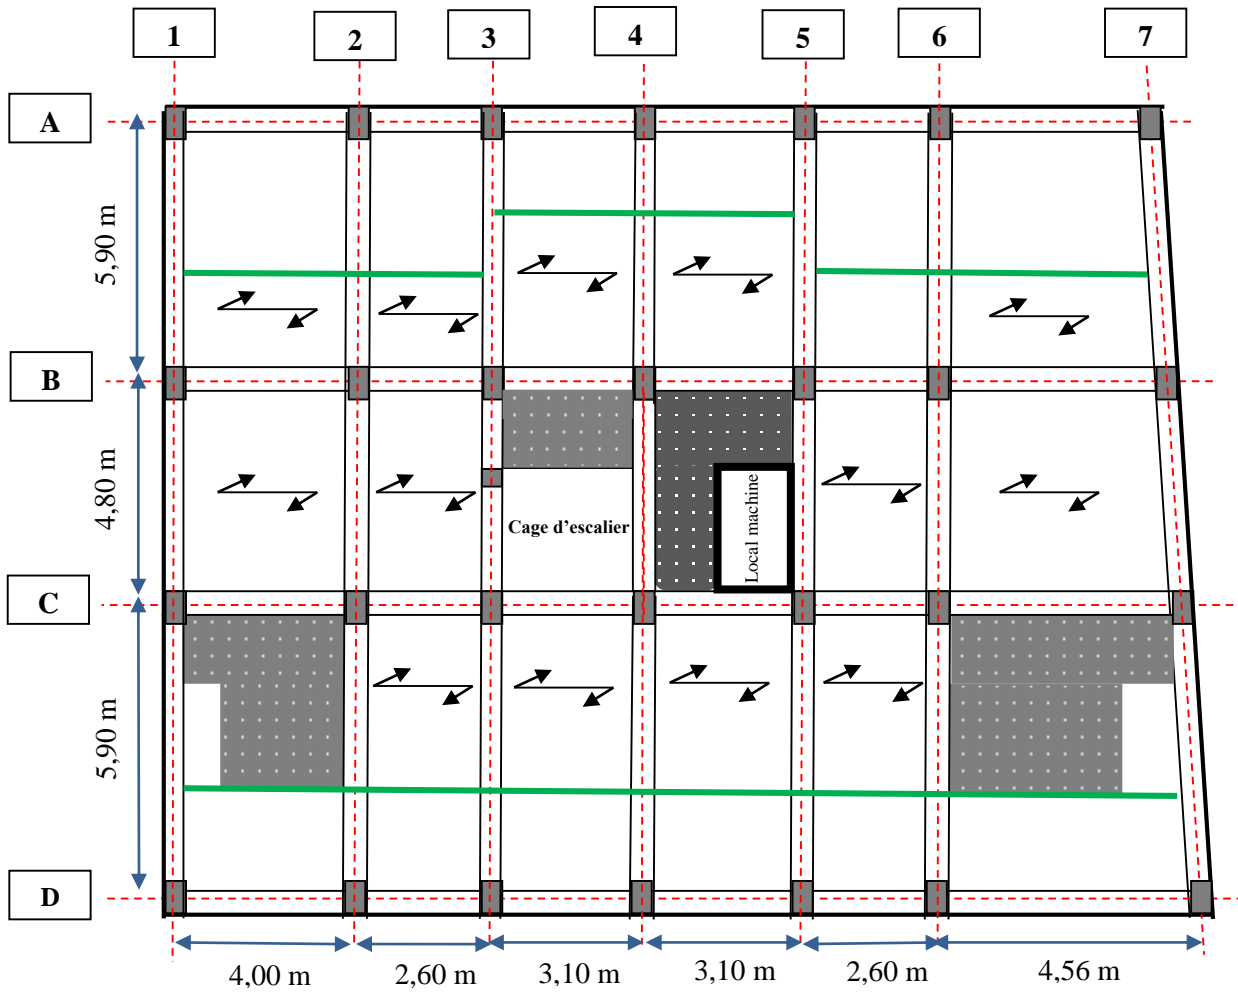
Plane de disposition des poutrelles duplex niveau 1
